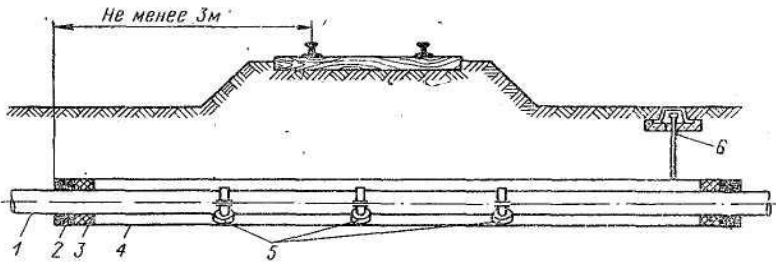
Схема пересечения газопроводом электрифицированной железной дороги:
